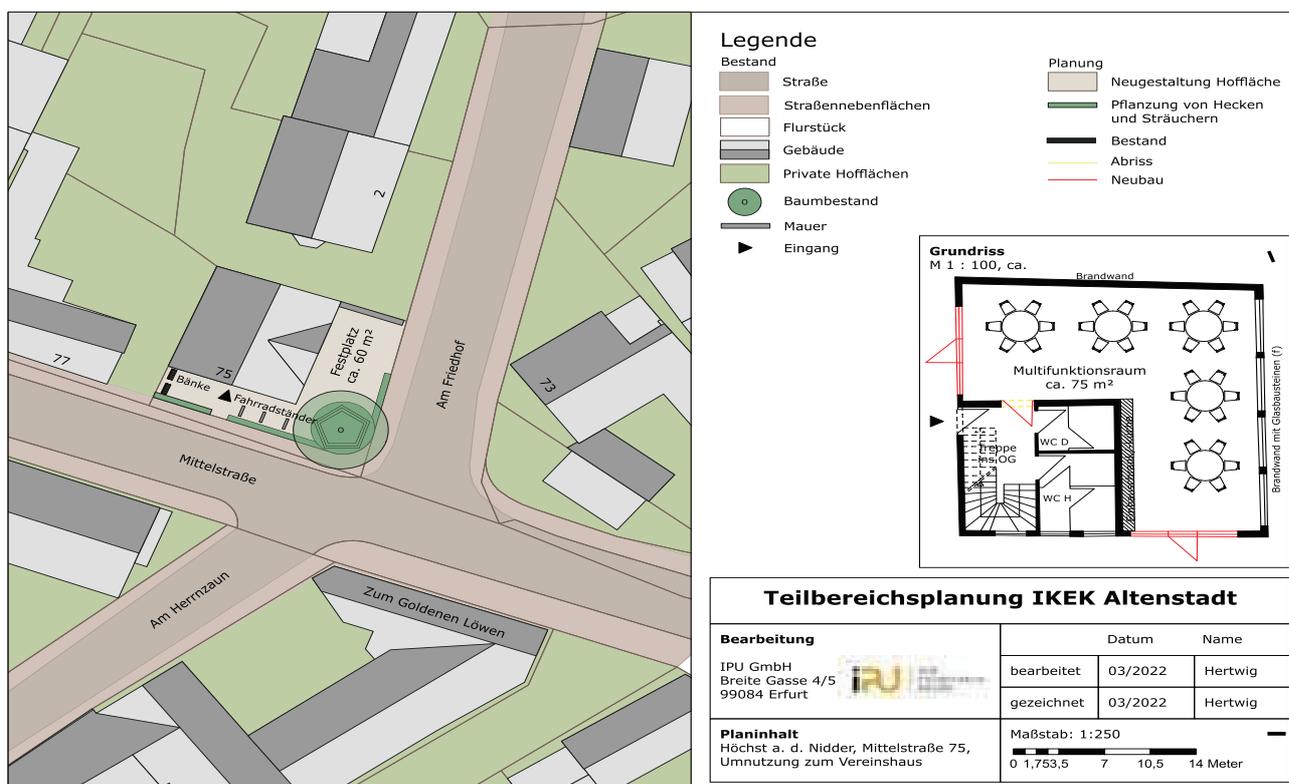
Planungsskizze Vereinshaus in der Mittelstraße in Höchst, Quelle: Eigene Darstellung
